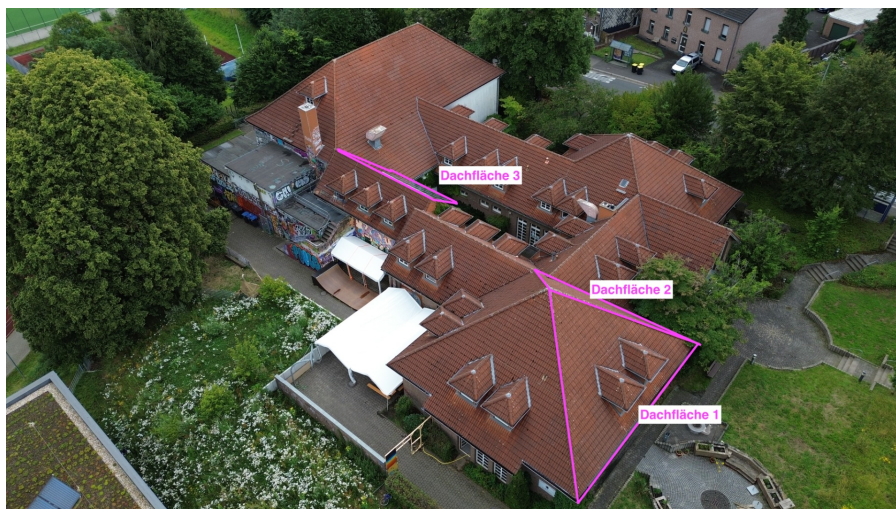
Drohnenaufnahme mit markierten Dachflächen die belegt werden sollen
